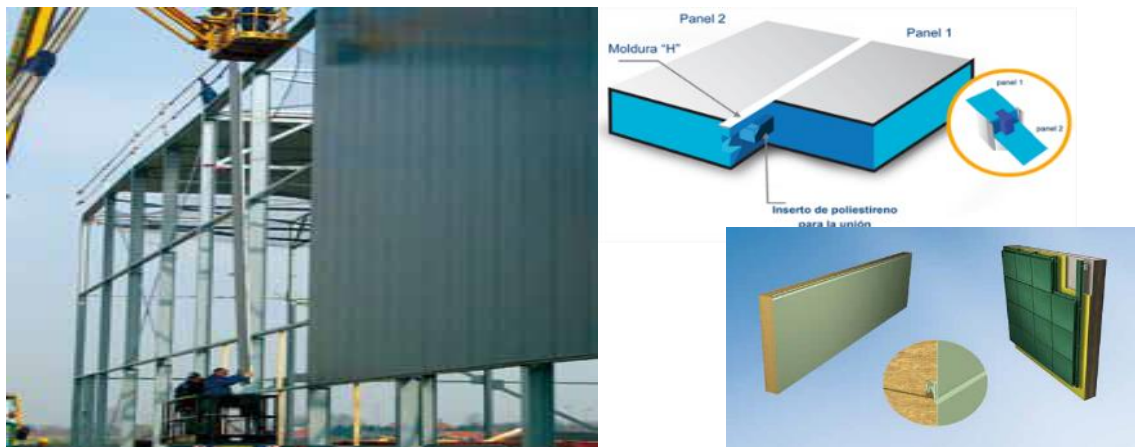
Detalle de envoltente en muros y detalle de paneles tipo sándwich. Fuente: <http://sections.arcelormittal.com>, unypanel.com
